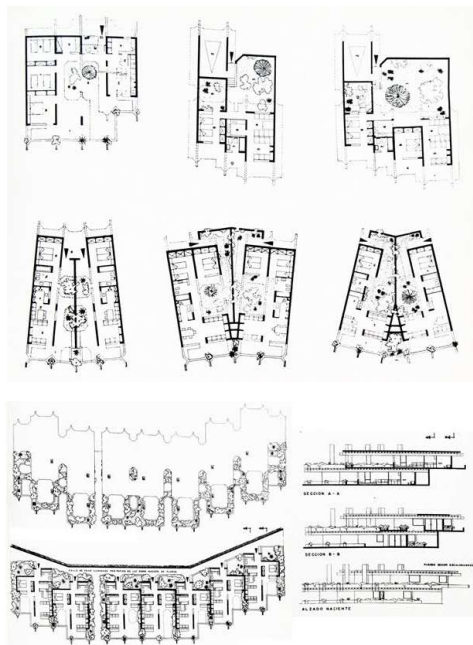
Plan Parcial de Lanzarote, vivienda de protección oficial (1963).
